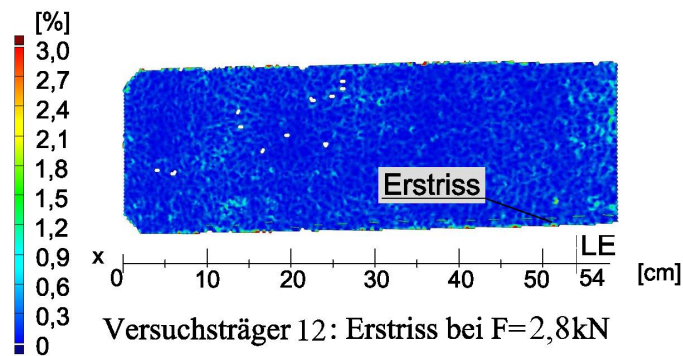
Versuchsträger 12- Lage Erstriss
